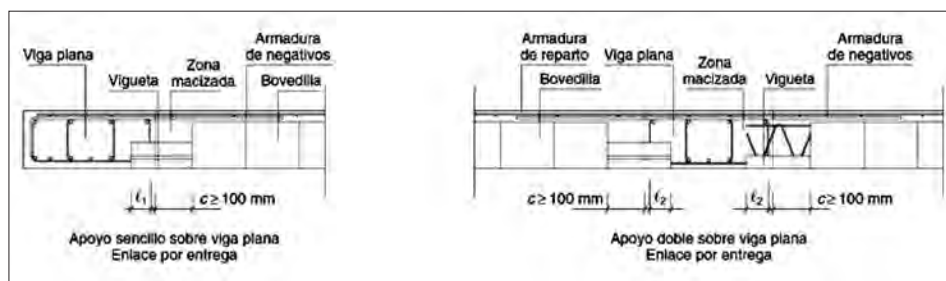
y 28: apoyo sobre viga plana. Enlace por entrega.
